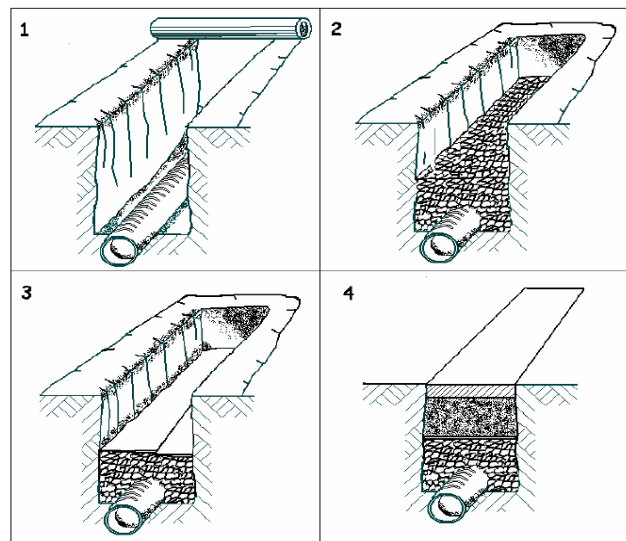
Esquema de la secuencia constructiva de la trinchera drenante tipo.
